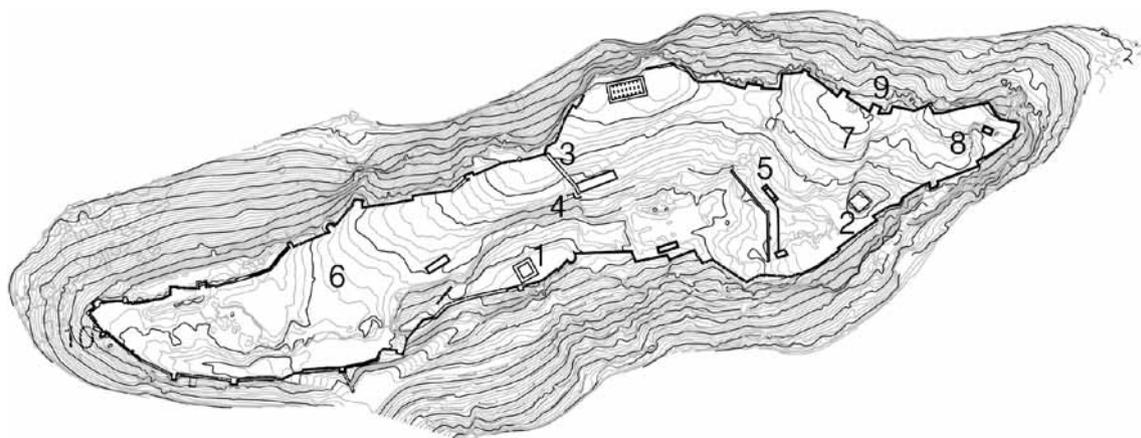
Plano de la alcazaba de Lorca con las diferentes partes y elementos de la fortificación. 2.1. Torre exenta 1. 2.2. Torre exenta 2. 2.3. Muralla del Espaldón. 2.4. Puerta en codo de la muralla del Espaldón. 2.5. Alcázar. 2.6. Albacar. 2.7. Barrio de Alcalá. 2.8. Barrio oriental. 2.9. Puerta del Pescado. 2.10. Puerta Falsa.
